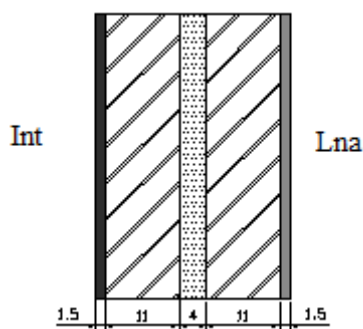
Pormenor construtivo da parede interior em contacto com zona comum
